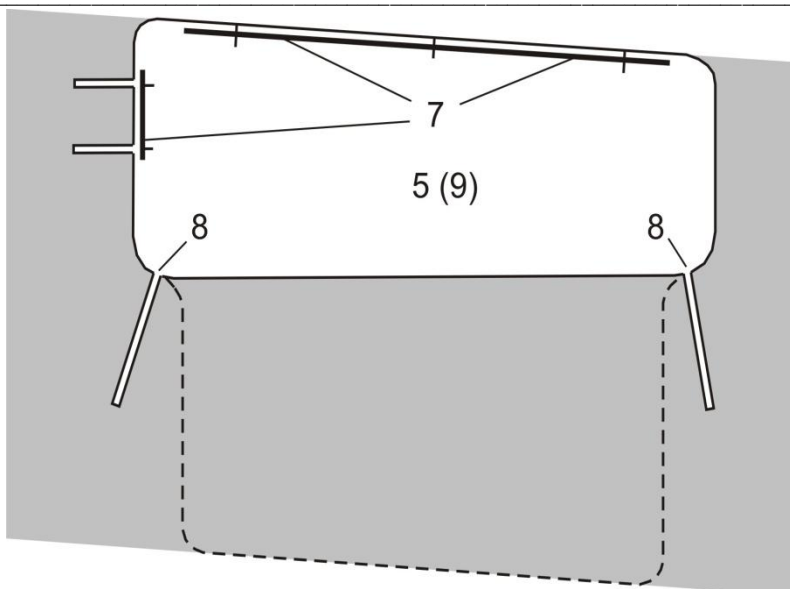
Поперечное сечение (А-А) выемочной камеры и заходки в слое у кровли пласта
